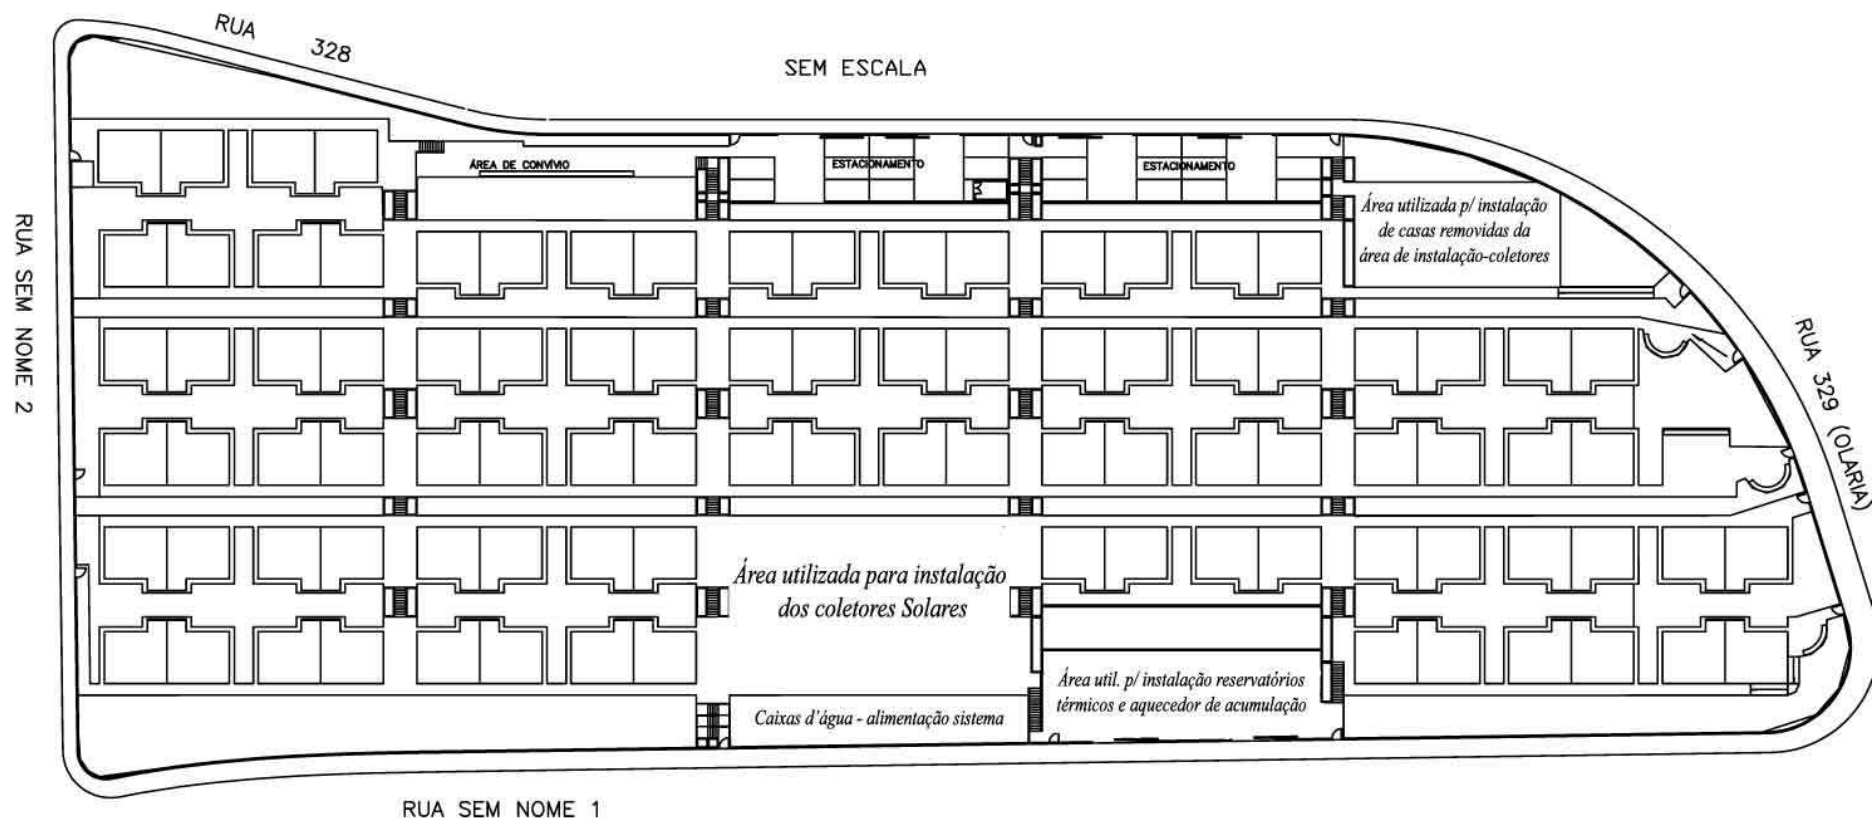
Planta indicativa da proposição de implantação do sistema de aquecimento distrital.
